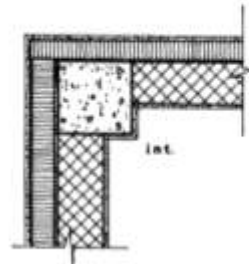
A-3: Pilastro d'angolo: correzione del ponte termico con isolamento dall'esterno in fibre minerali orientate e piccolissimo spazio profitti da lavori in finisci.
